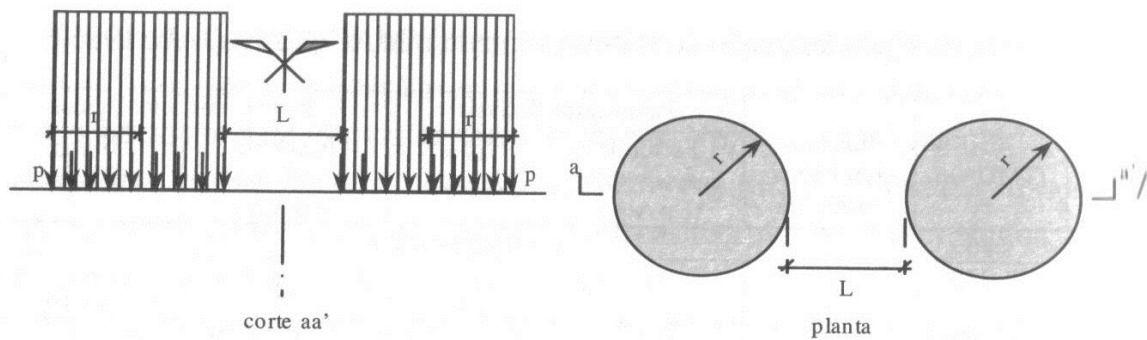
Esquemática da acção de um eixo padrão sobre um pavimento (Branco et al., 2008)
